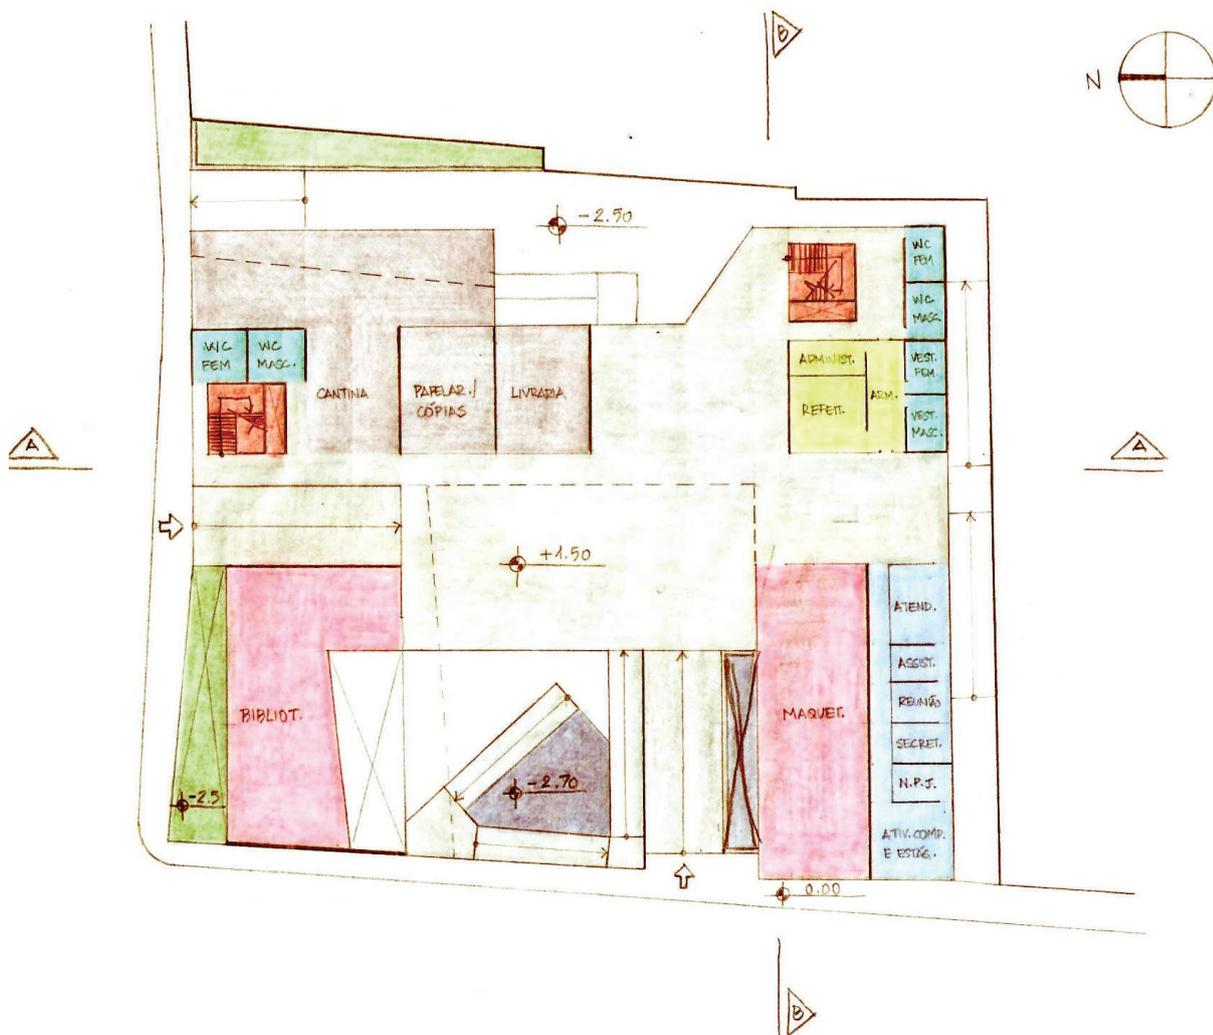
Proposta 4, estudo preliminar, Planta do Térreo
